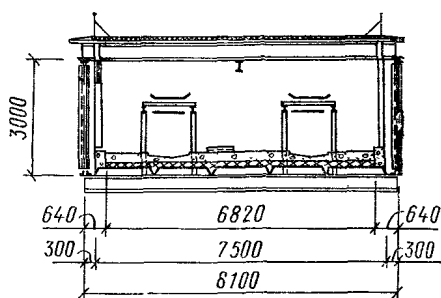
Поперечный разрез отопляемой галереи с облегченными конструкциями
